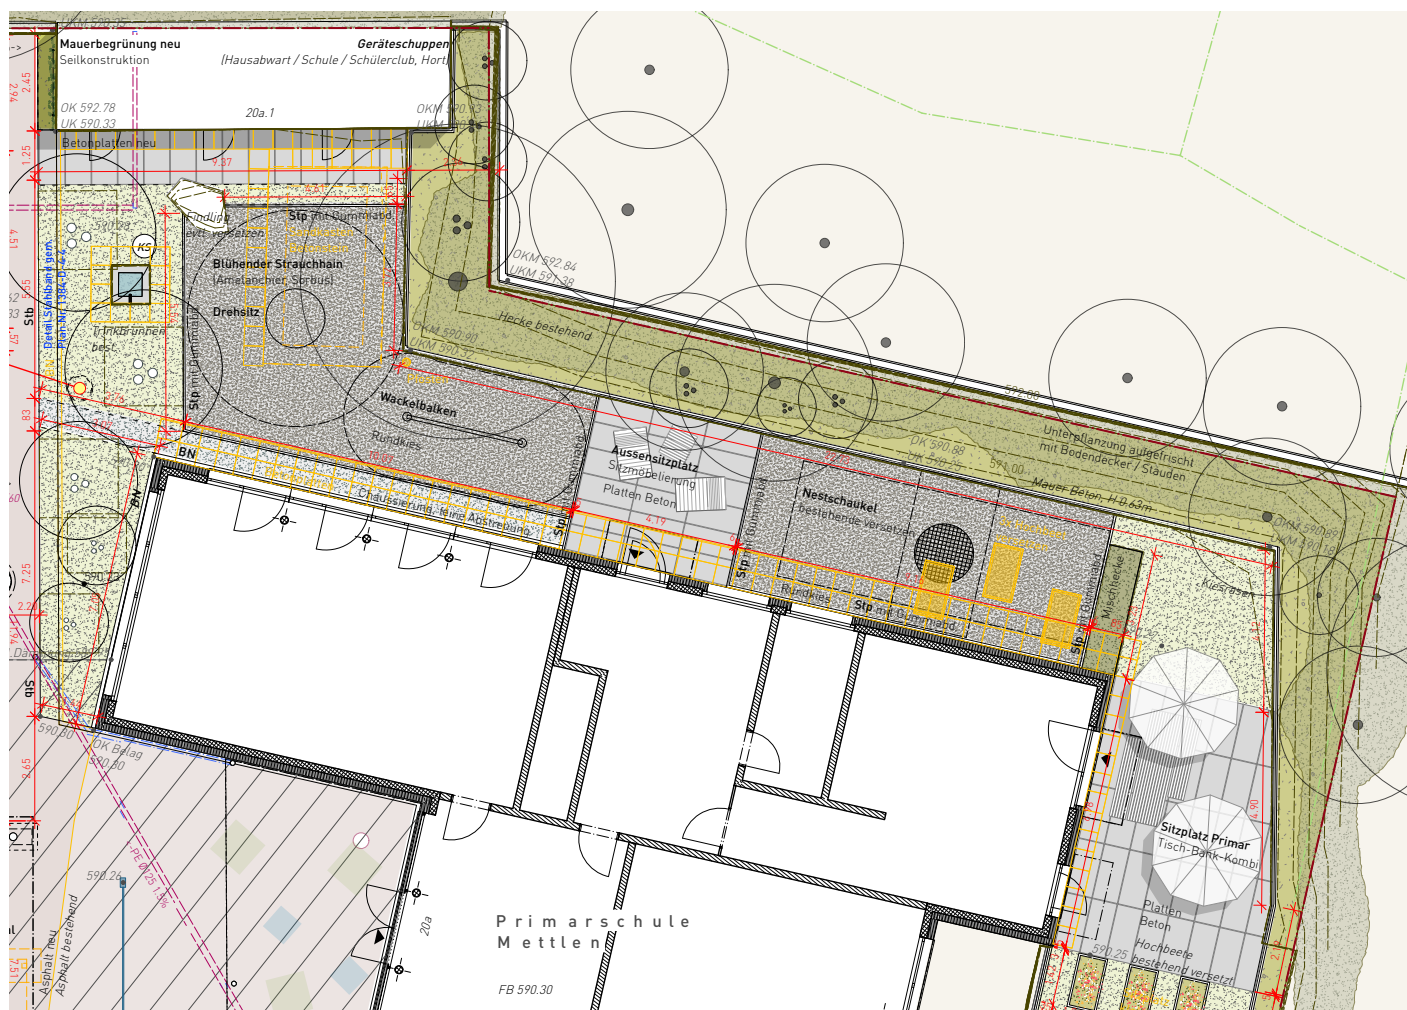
Planausschnitt Umgebungsanpassung Teilprojekt 2
